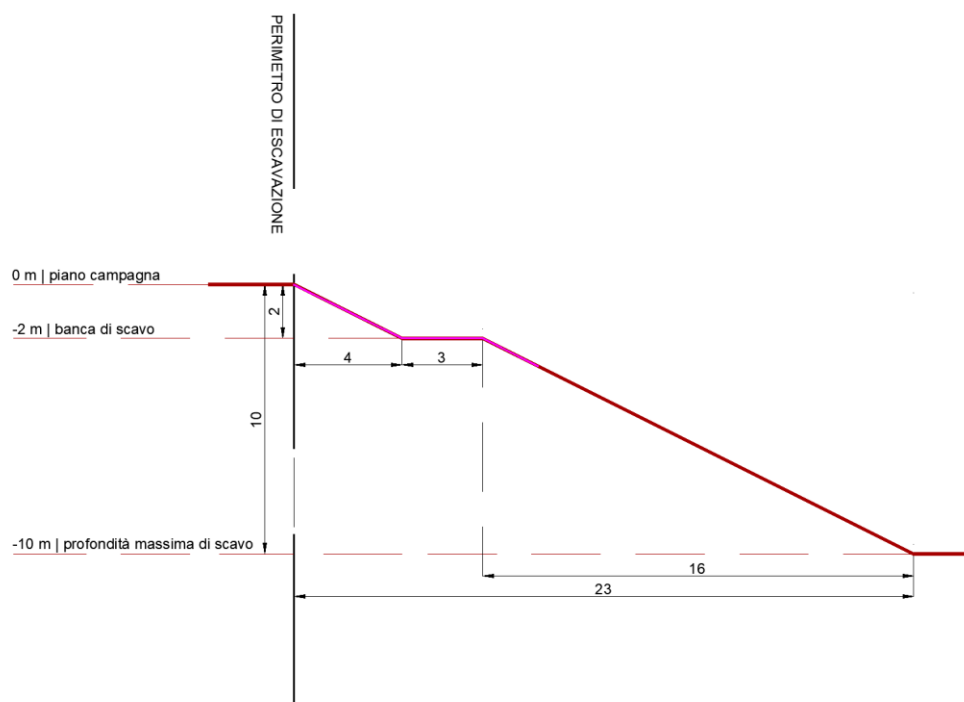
SCHEMA DI PROGETTO DELLA SEZIONE DI SCAVO DEL NUOVO POLO ESTRATTIVO
